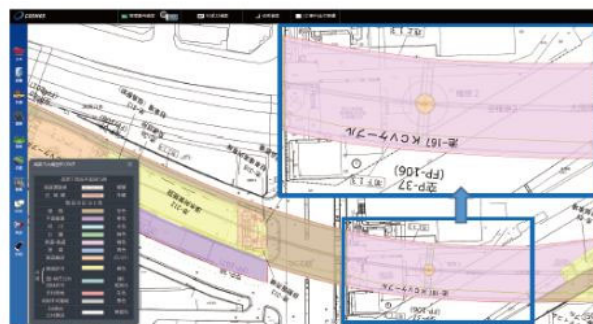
道路台帳平面図と高架下占用図の重ね合わせ
